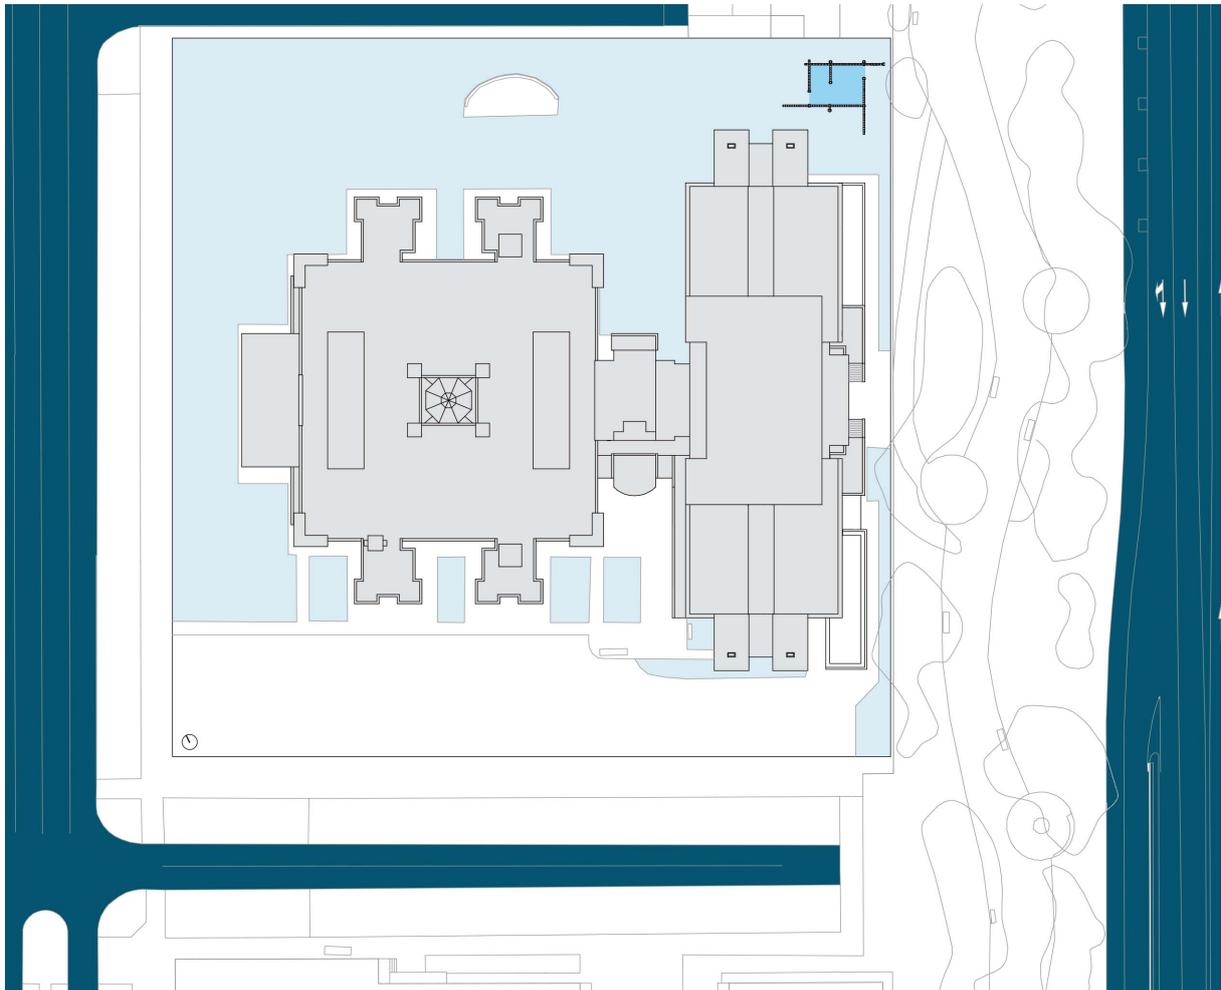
Planta de situación ETSAVA, escala 1:20000. Elaboración propia.
